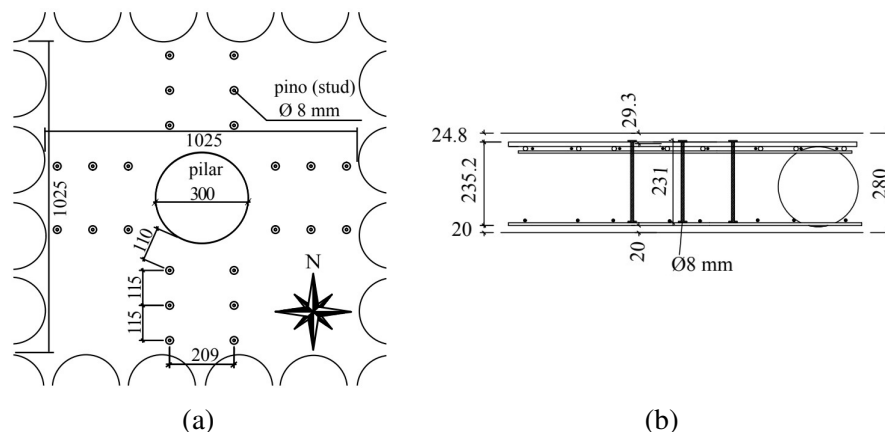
Studs* em (a) planta e (b) corte (mm) (Ceballos (2017))
